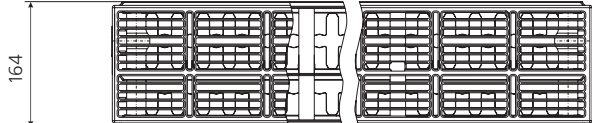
Радиатор «PRADO Universal» в разрезе, с двумя нижними и четырьмя боковыми присоединительными отверстиями
